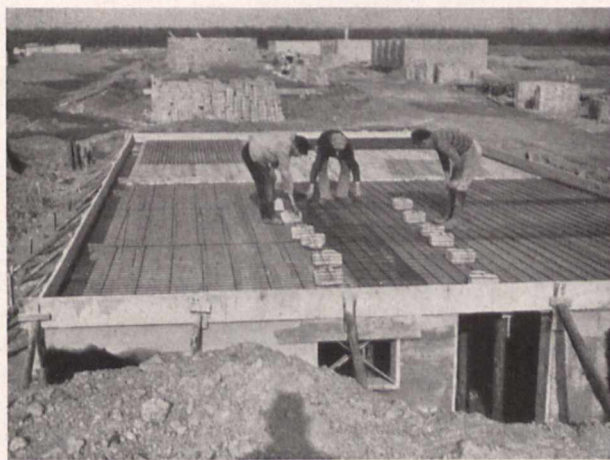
Auch für Kleinhausdecken kann man durch Verwendung von Baustahl statisches Eisen sparen
